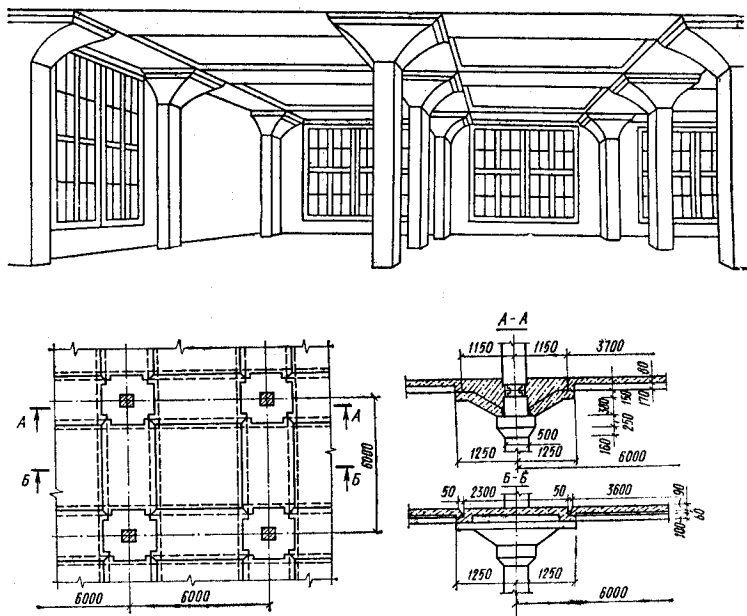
Конструкция безбалочного сборного перекрытия с ребристыми панелями
